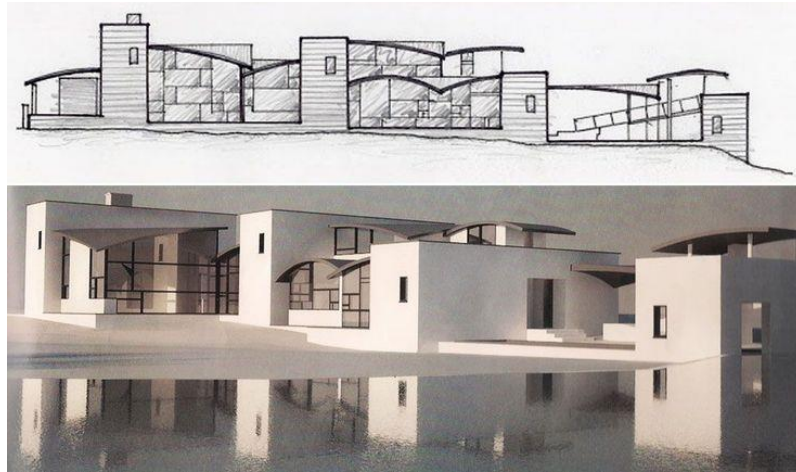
Maqueta y sección de la Stretto House. Steven Holl.
